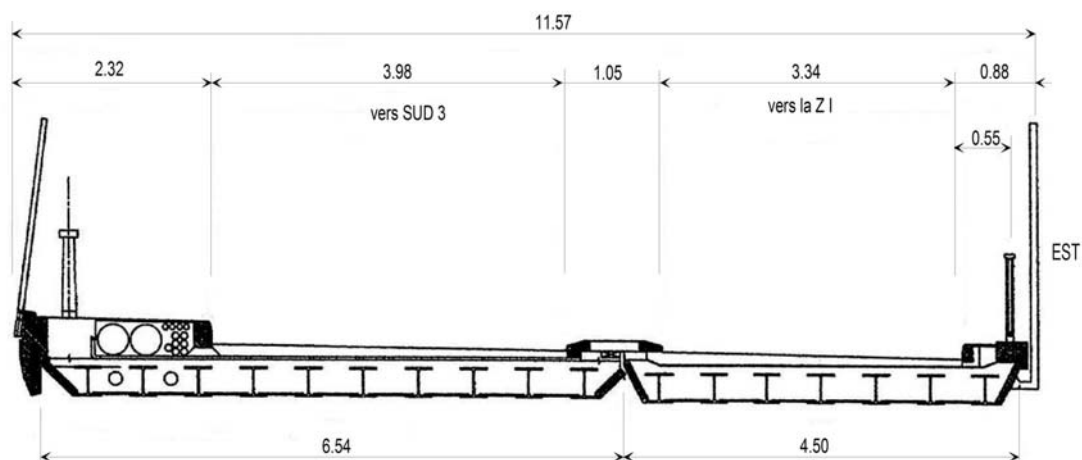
Coupe transversale du tablier de l'ouvrage existant
